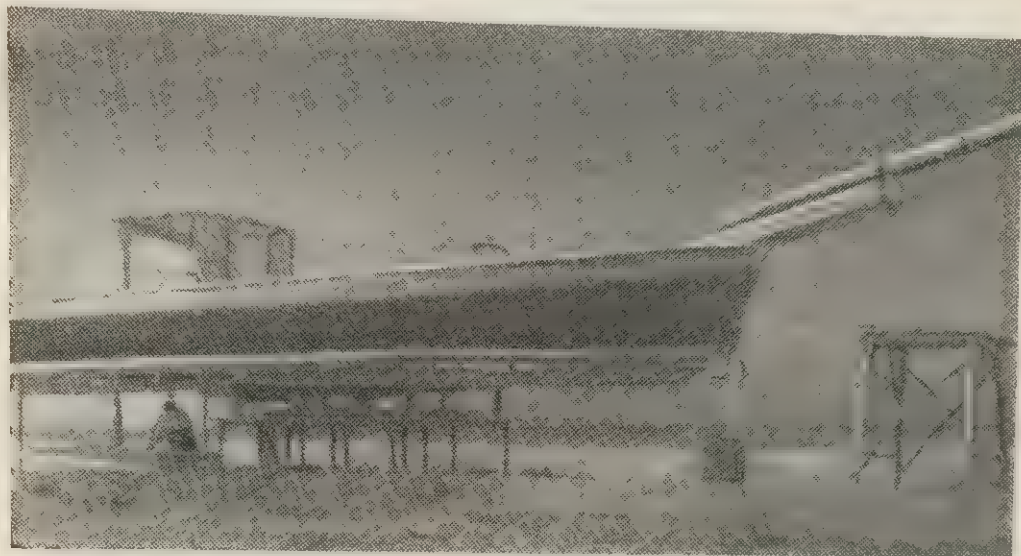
Рабочий момент сборки декорации на качающейся платформе
